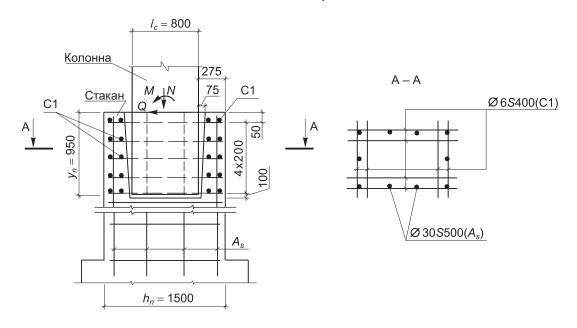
Армирование стаканной части подколонника к примеру Г.11
